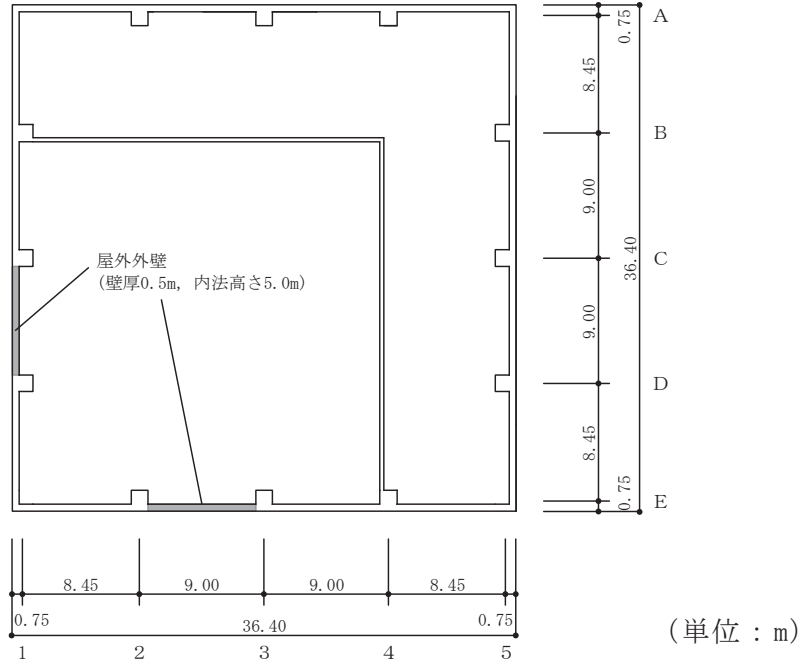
(1) 緊急時対策建屋の概略平面図 (0.P. 69.4m)
